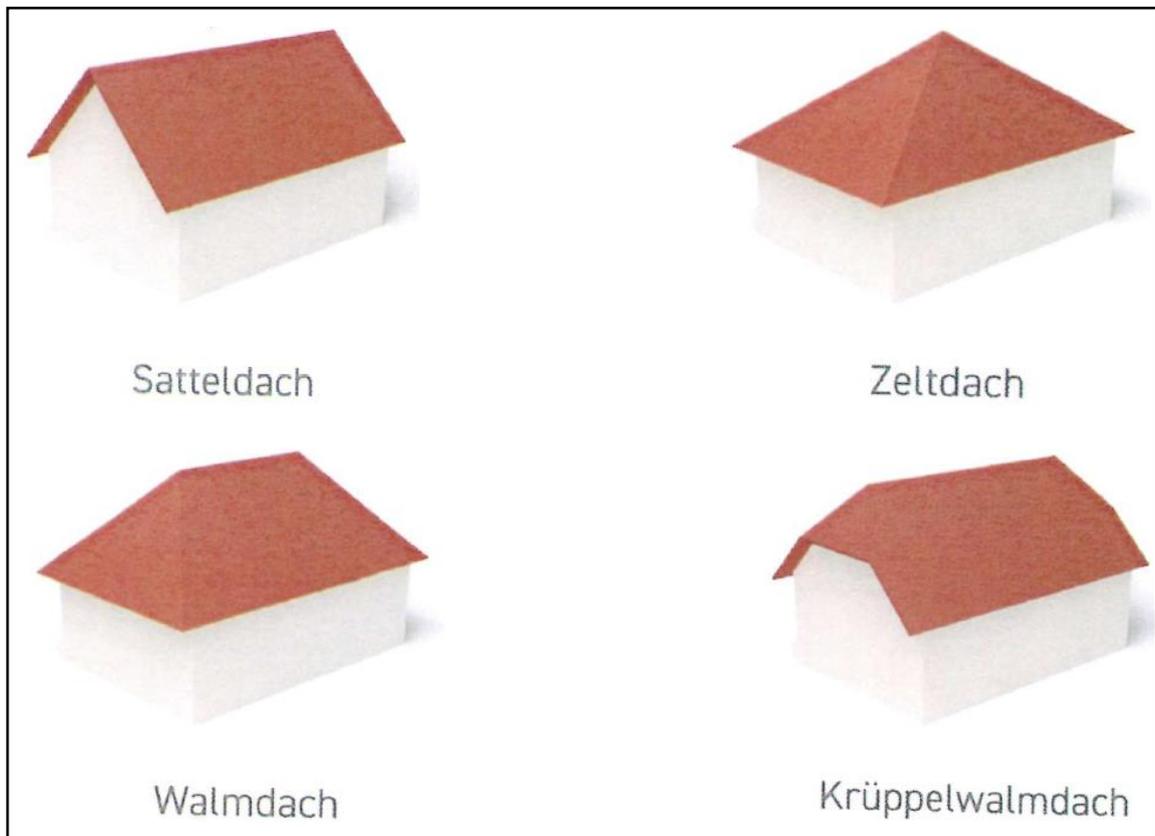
Beispielzeichnung für zulässige Dachformen der Hauptgebäude
